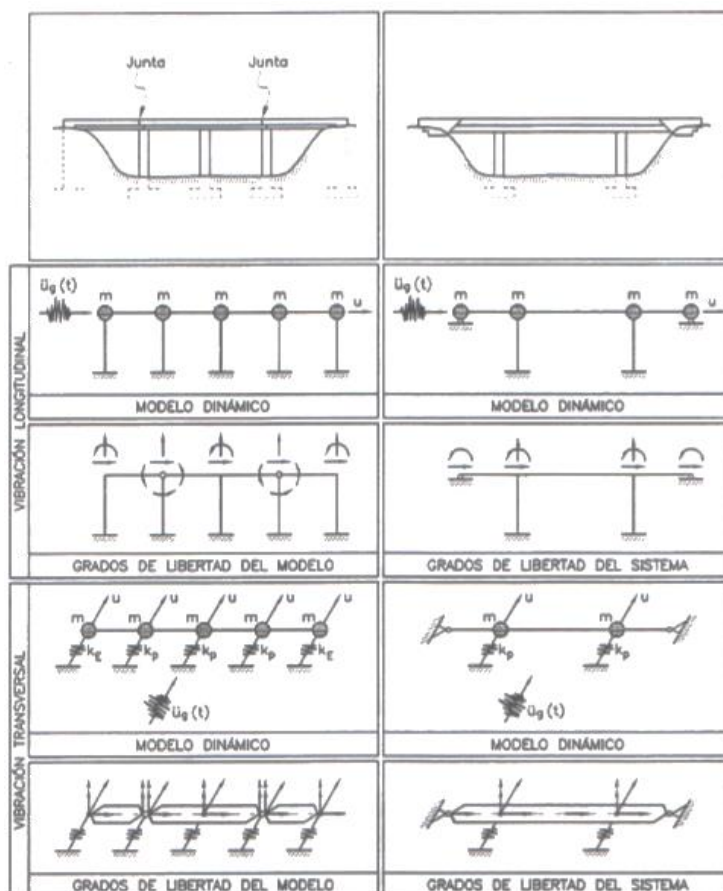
Ejemplo de modelación estructural de puentes (Maldonado, Canas, Casas, & Pujades, 1998)
